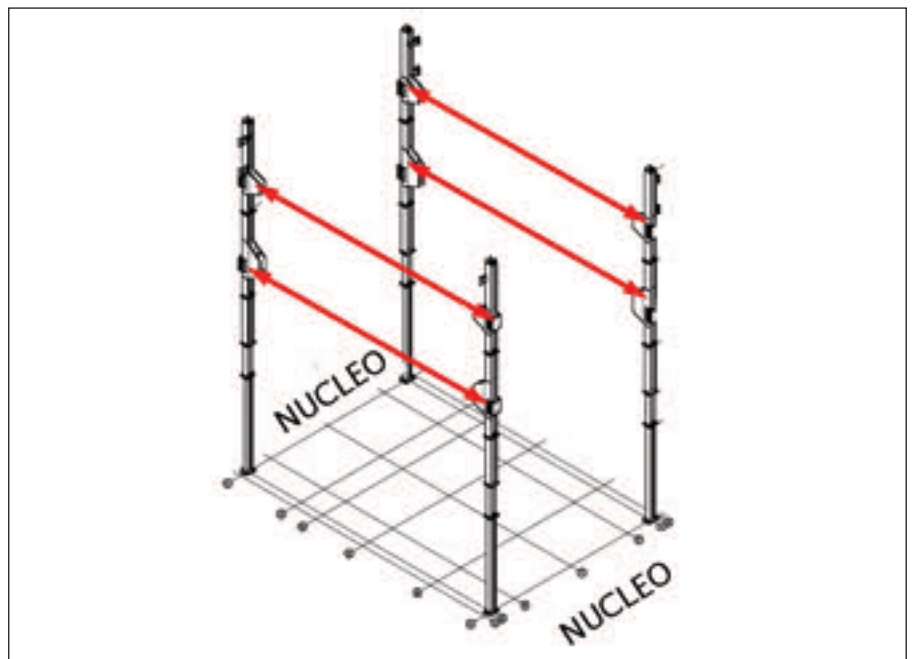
Columnas embebidas con cartelas de montaje a las que se conectan las cerchas principales
